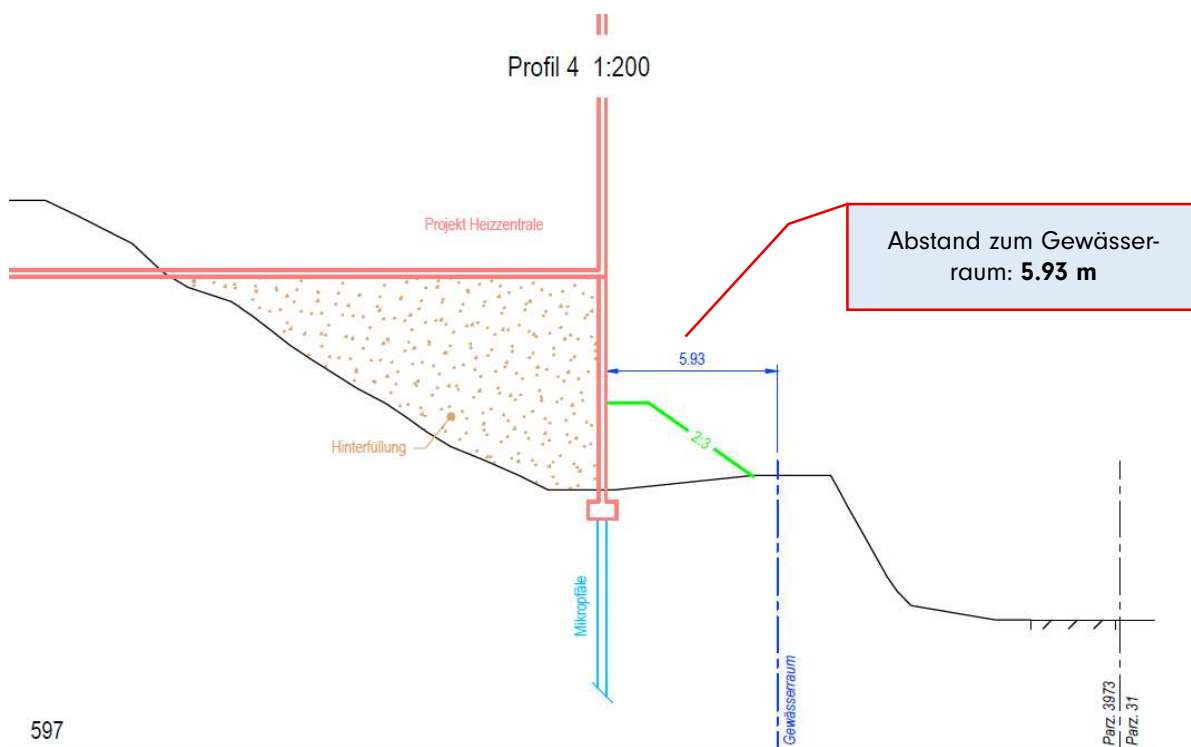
Abstand äusserste Ecke Erweiterungsbaus zum Gewässerraum
